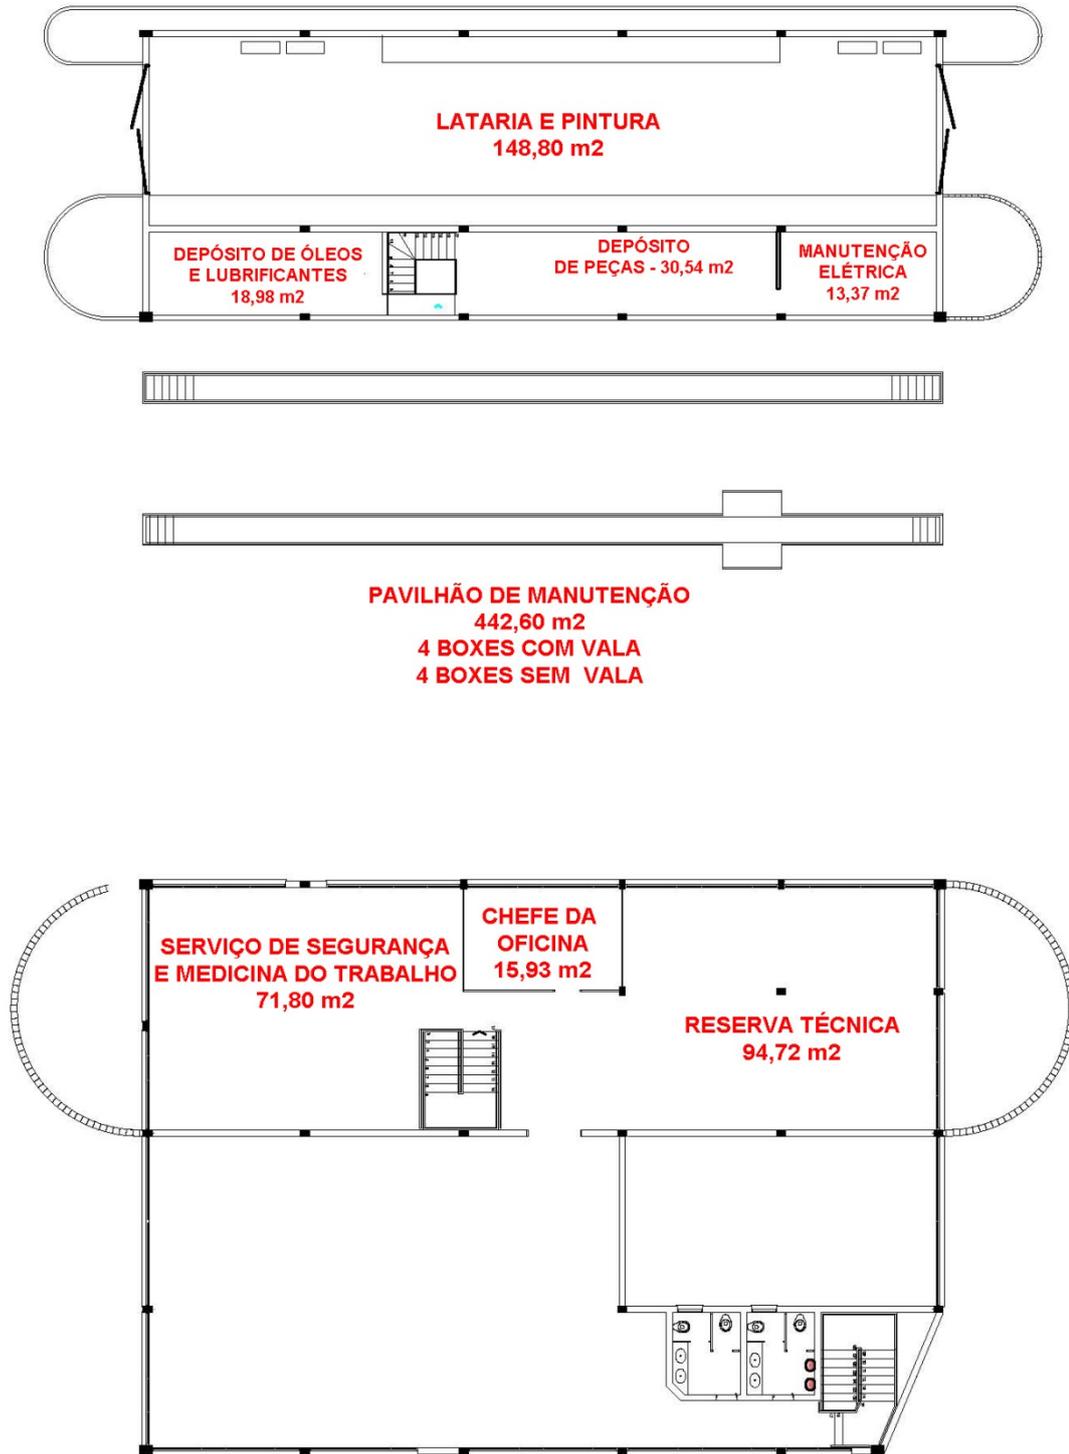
Lay Out da Oficina Mecânica - 2º Pavimento
